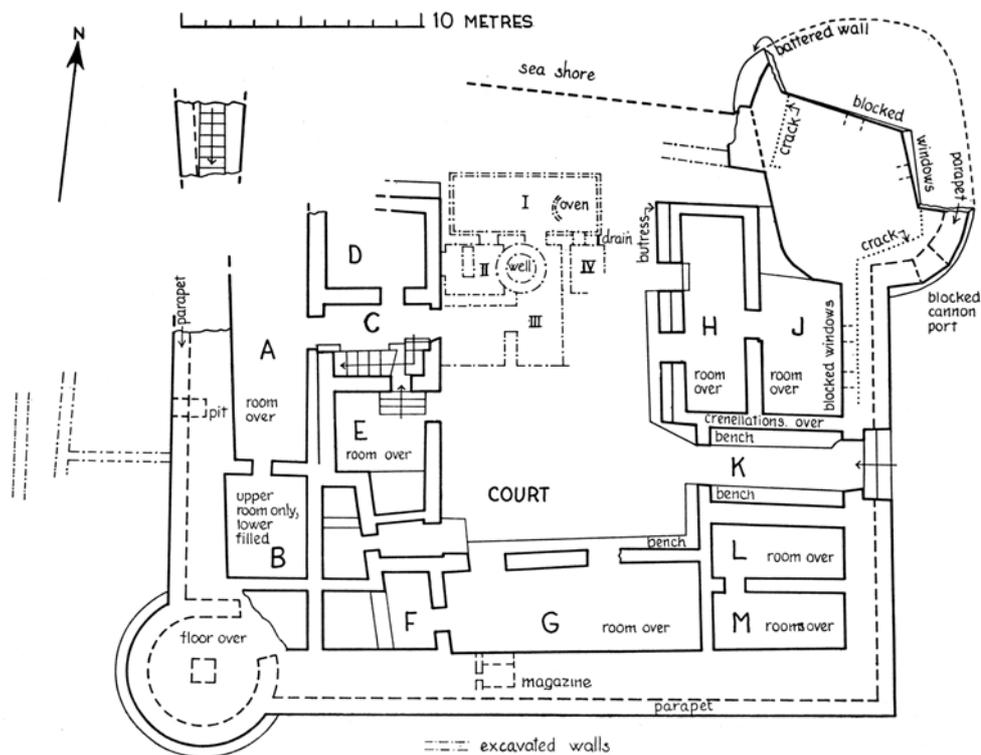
Grundriss vom Gereza (Fort)
